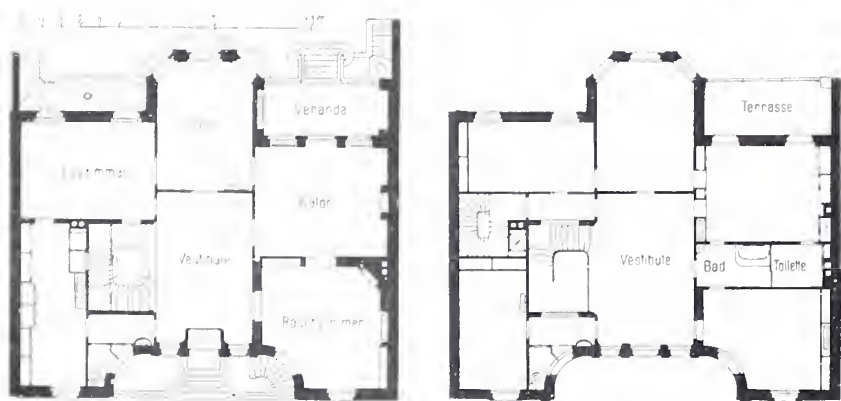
und 21. Grundrisse vom Erdgeschoss und I. Stock der Villa L. R. B.
